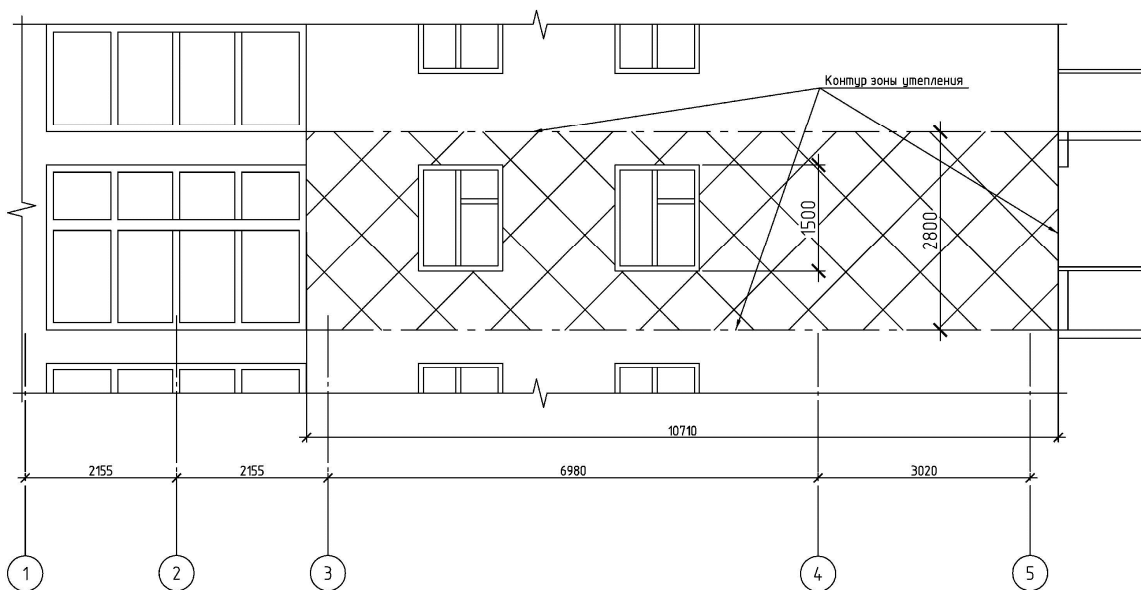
Фасад квартиры в осях «1-5» / The facade of an apartment in the axes «1-5»
